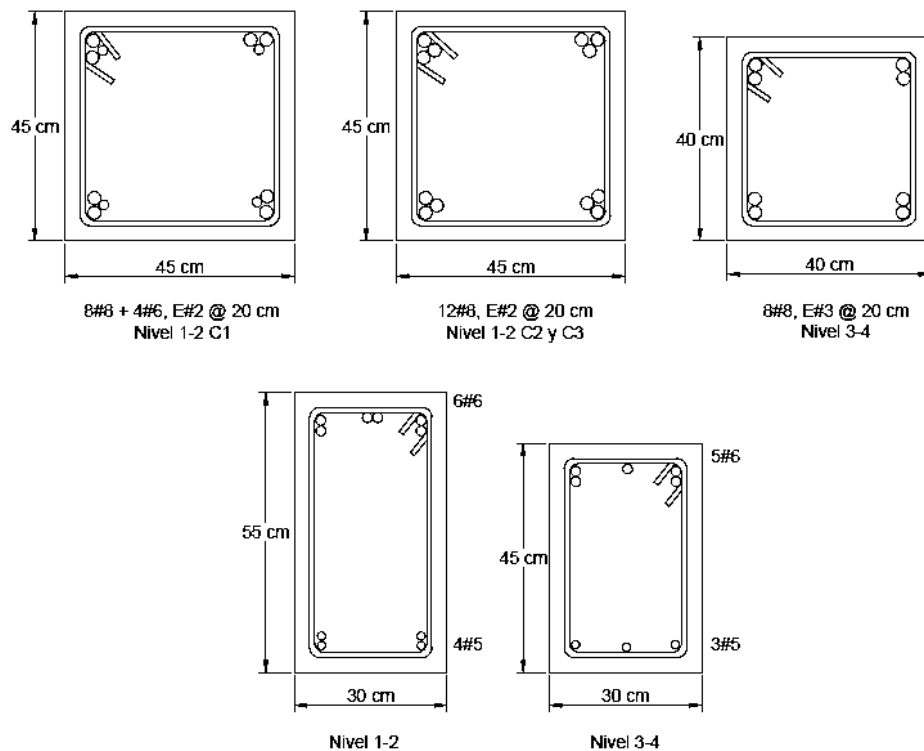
Secciones finales de columnas y vigas del edificio de 4 niveles diseñado con las NTCS-1976 y  $Q=4$  [imágenes tomadas de Gregorio, 2020]
